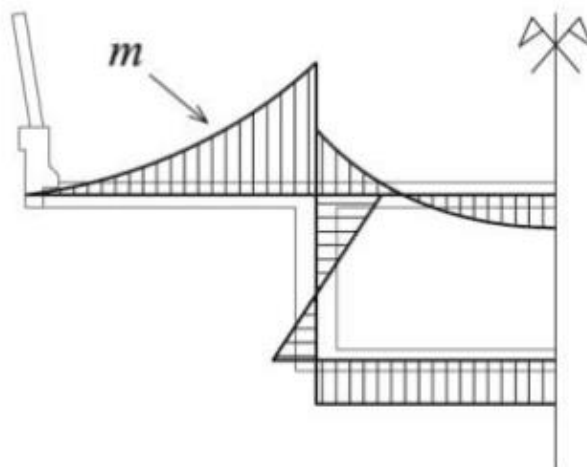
Flexão transversal presente na secção de viga-caixão (Backes et al., 2014)
